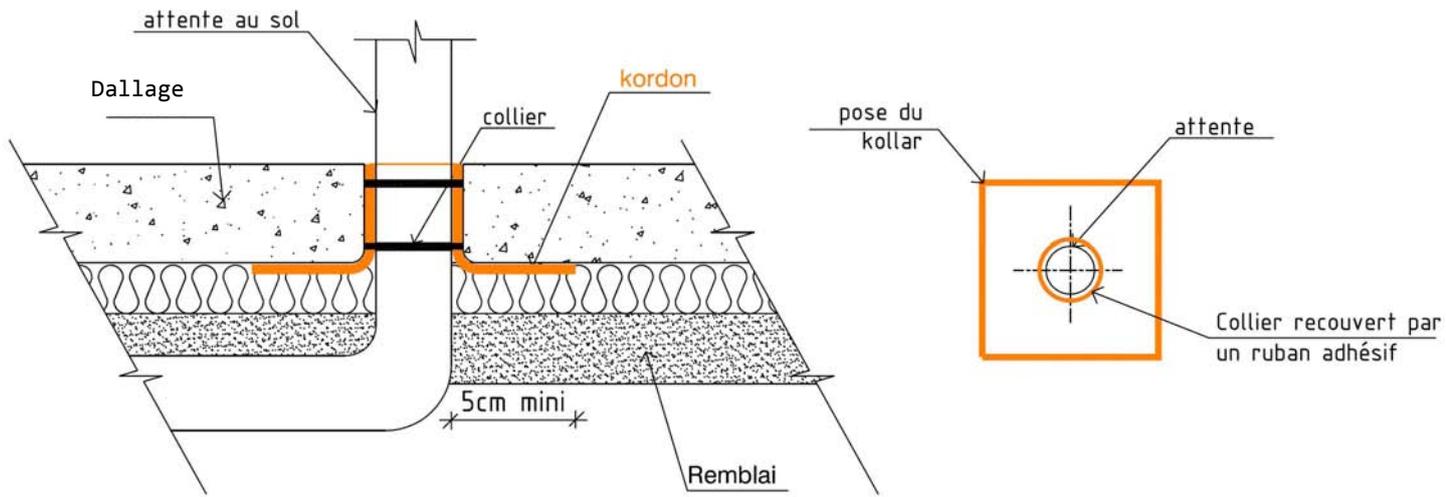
Traversées de dallage. Isolant sous dallage résistant aux termites.
